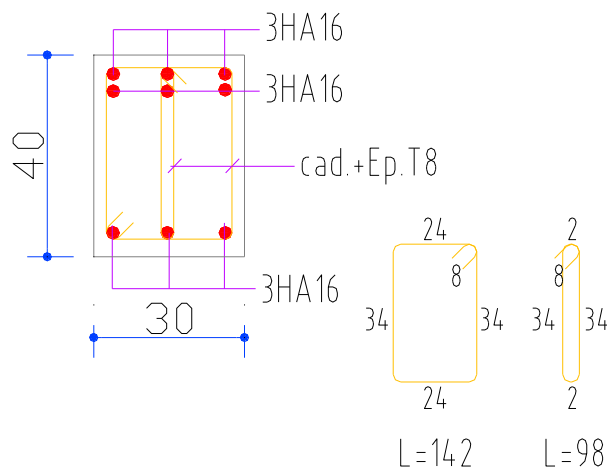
Ferrailage des poutres principales au niveau d'appui de 4^{ème} et 7^{ème} étage.
